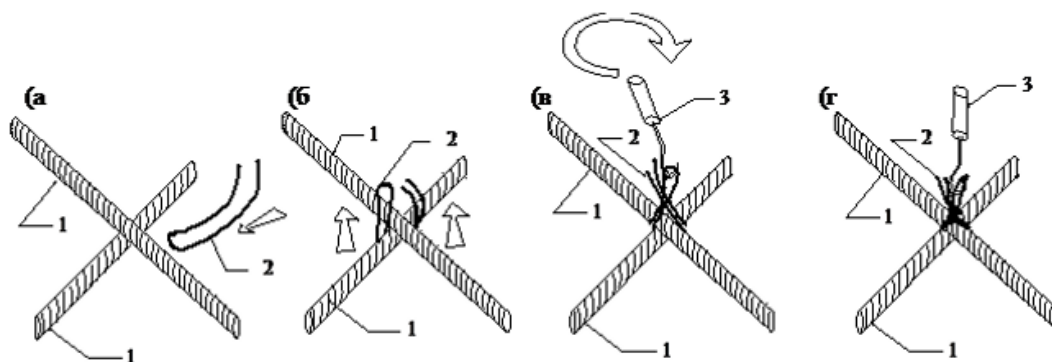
Схема фиксации арматурных стержней вязальной проволокой: а) протодергивание проволоки под узлом; б) выравнивание концов проволоки; в) скручивание концов проволоки вязальным крюком; г) зафиксированный узел. 1- арматурный стержень; 2-вязальная проволока; 3-вязальный крюк.
